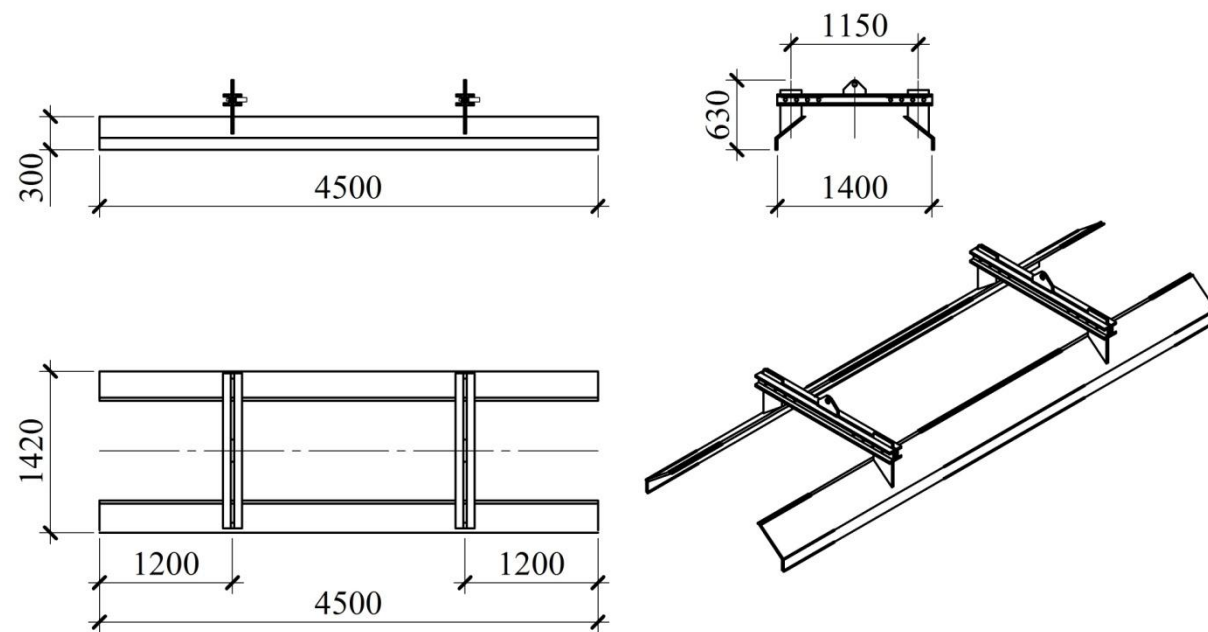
Конструкция блок-формы опалубки для возведения плит монолитных ленточных фундаментов
